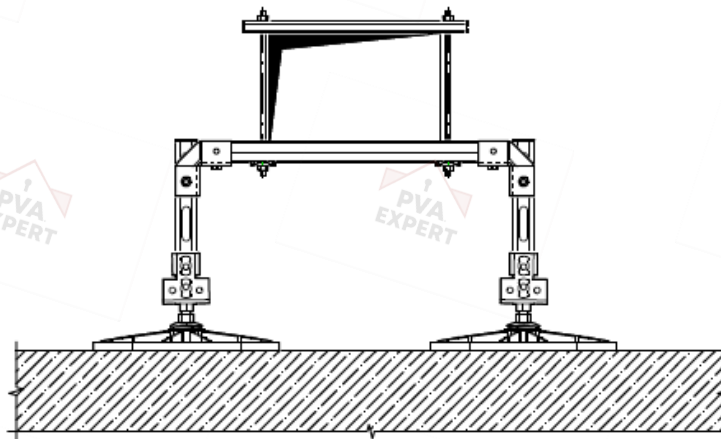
Узел крепления прямоугольного воздуховода на кровле
